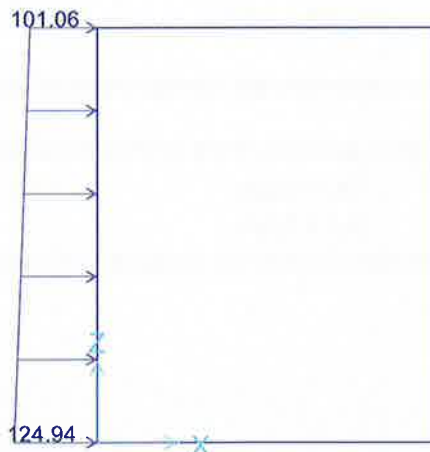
CARICO DISTRIBUITO DOVUTO ALLA SPINTA DEL TERRENO (SPTSX)
